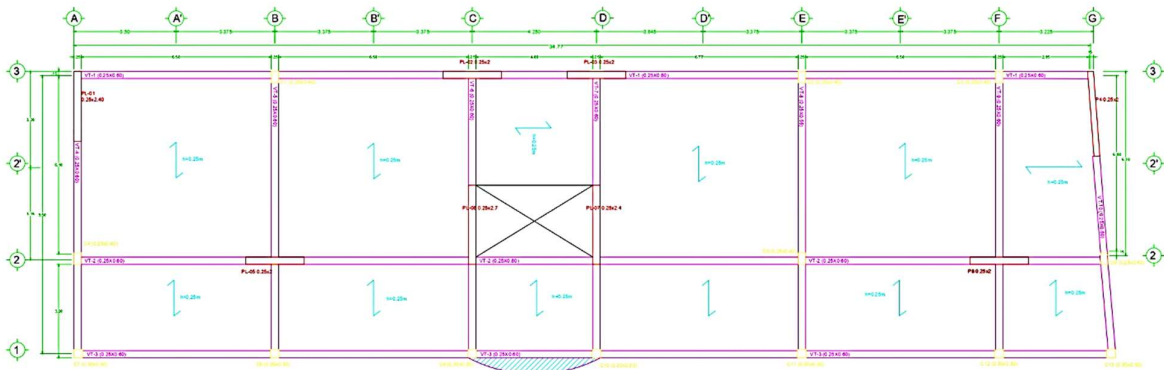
Plano casco estructural planta típico. Fuente: Propia
